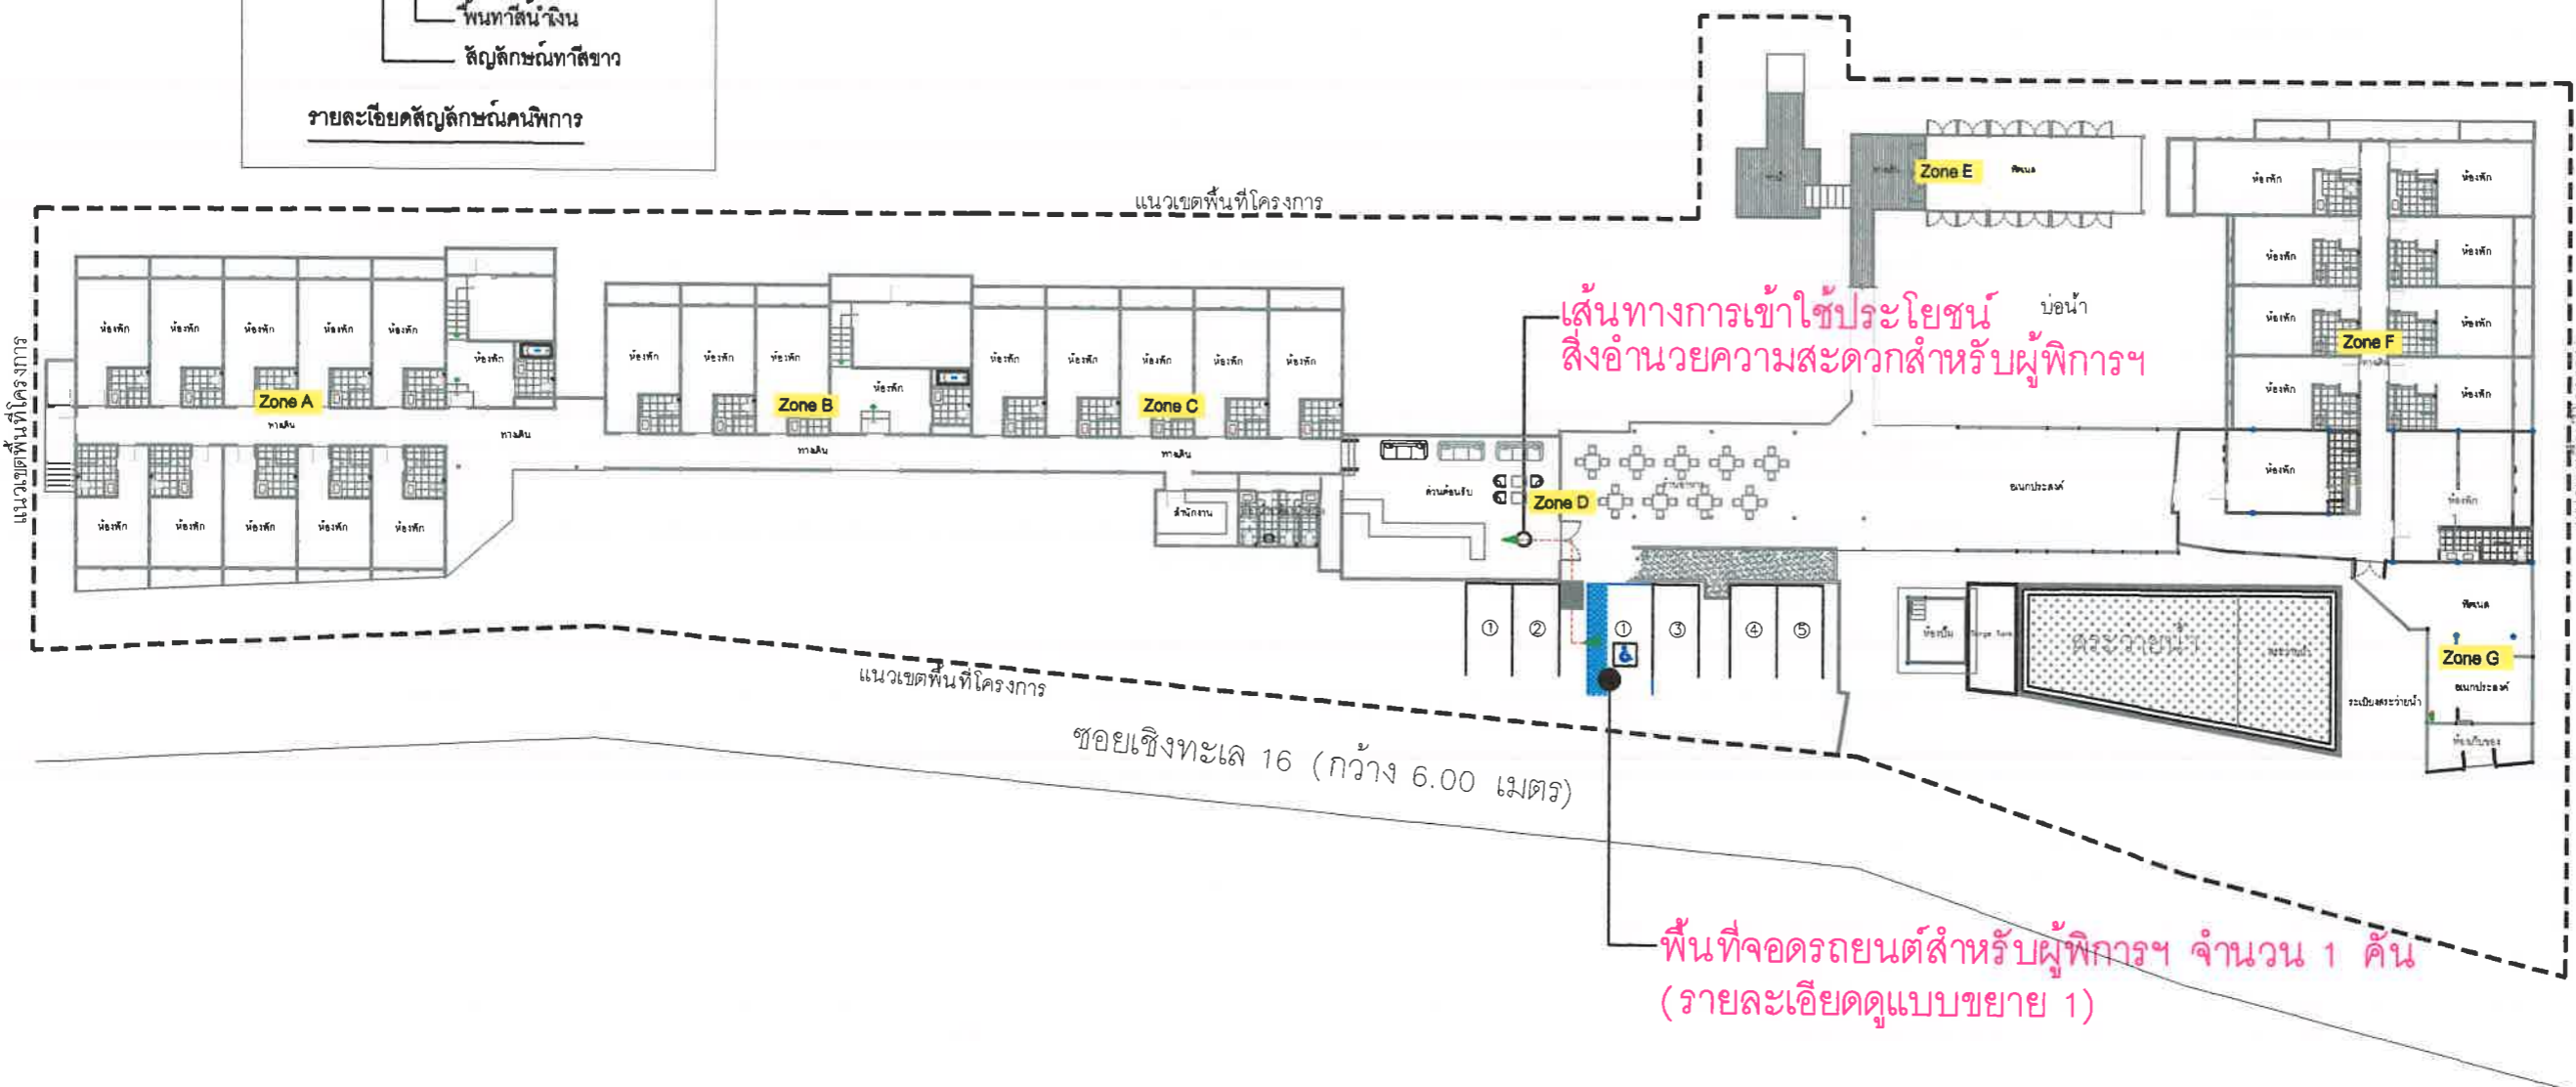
ผังระยะร่นอาคารของโครงการ
